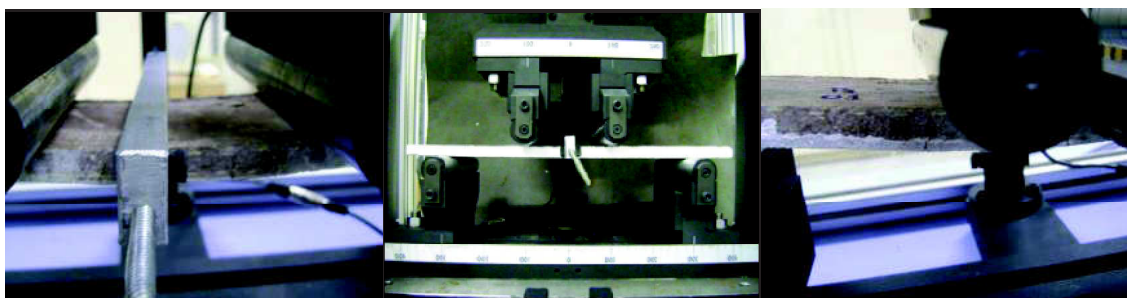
Surgimento das primeiras fissuras nas placas em função do carregamento recebido .
